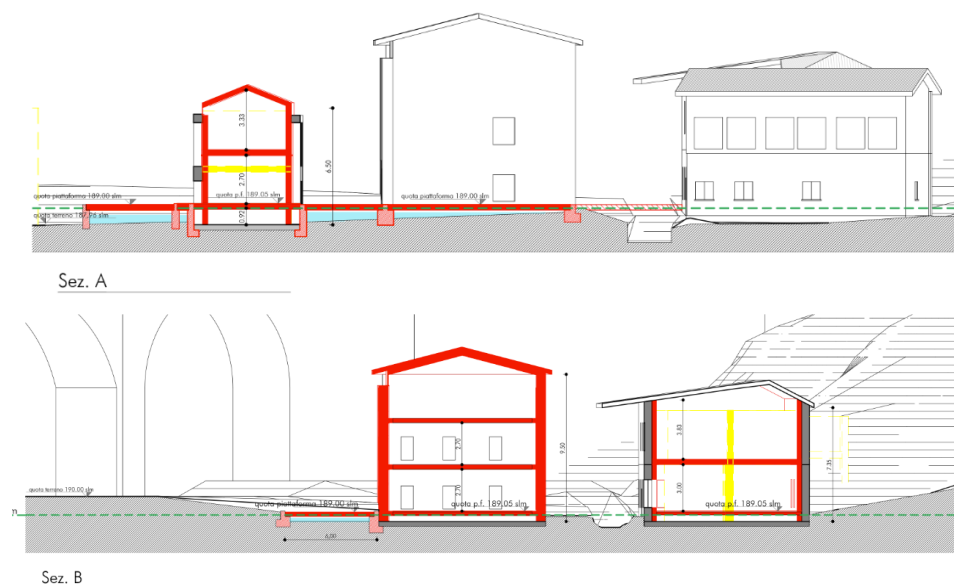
stralcio tavola 13 del piano di recupero, “planimetria generale di progetto e sezioni edifici da recuperare”
